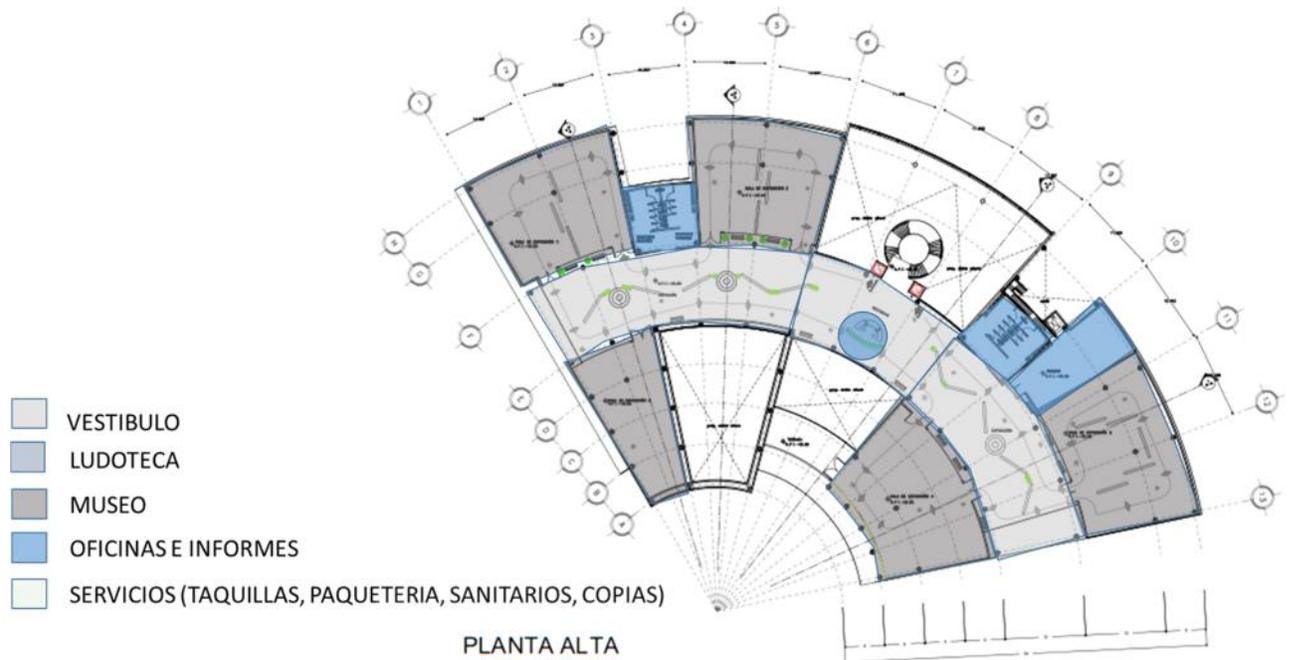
Zonificación planta alta. Fuente: el autor
